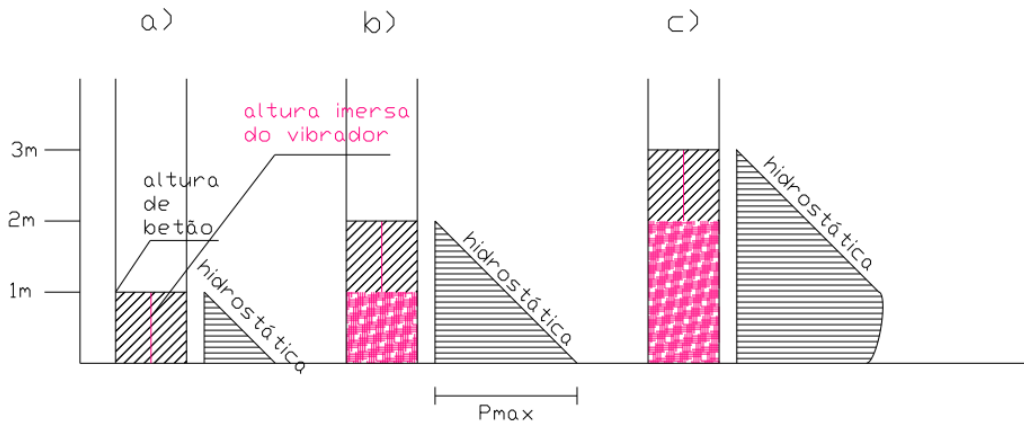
Exemplo da pressão que atua na cofragem de um pilar. (Fonte: Sá correia (2008))
